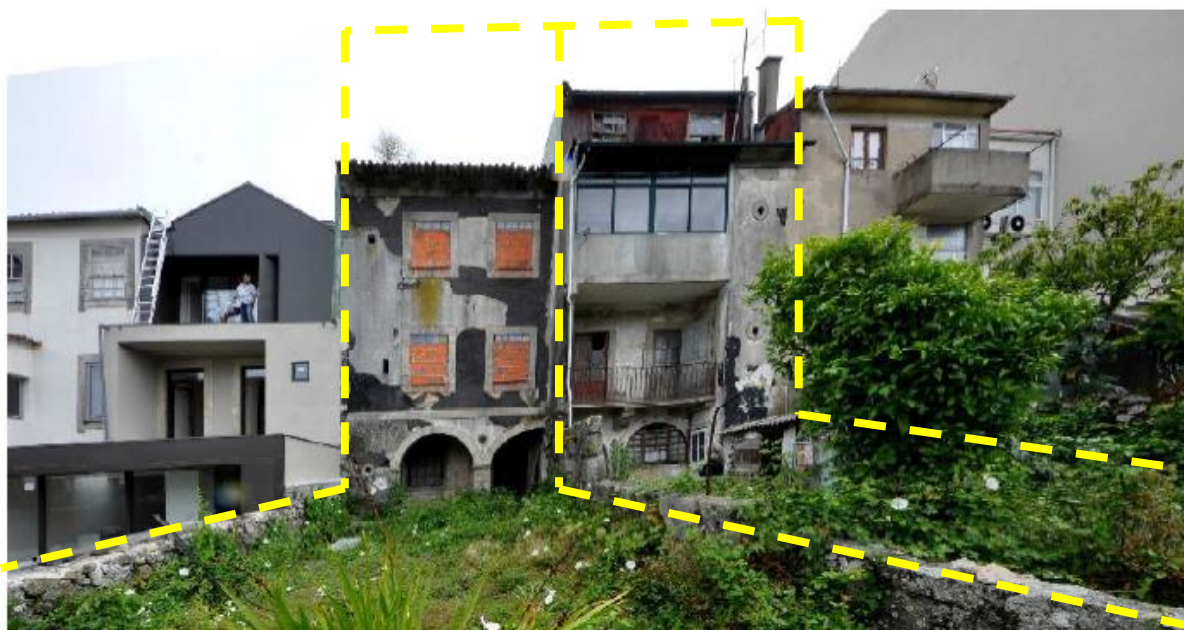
Aspeto da fachada posterior antes da intervenção.
